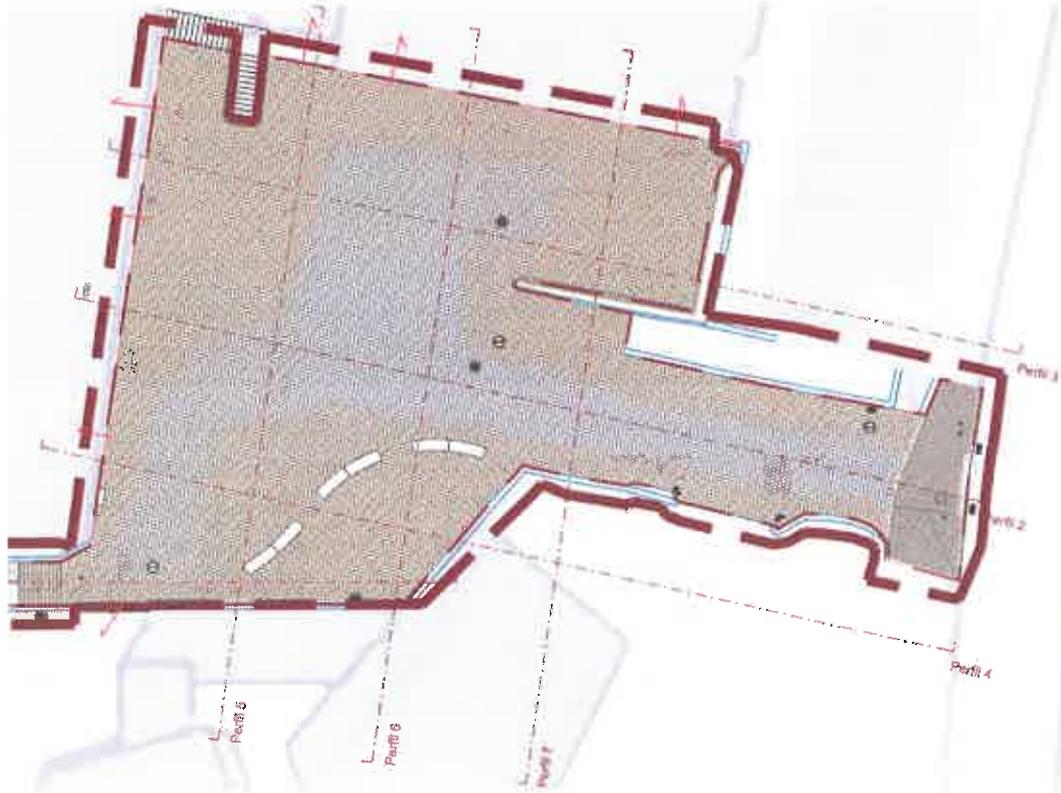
Proposta de Intervenção para a Praceta das Hortas – Sem Escala Aferida
